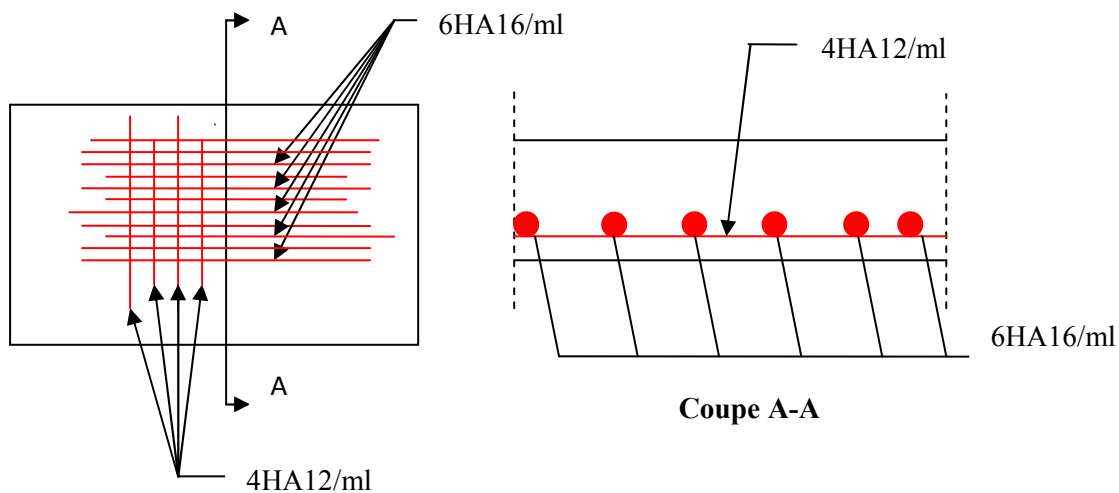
Schéma de ferrillage de la dalle sur trois appuis.
